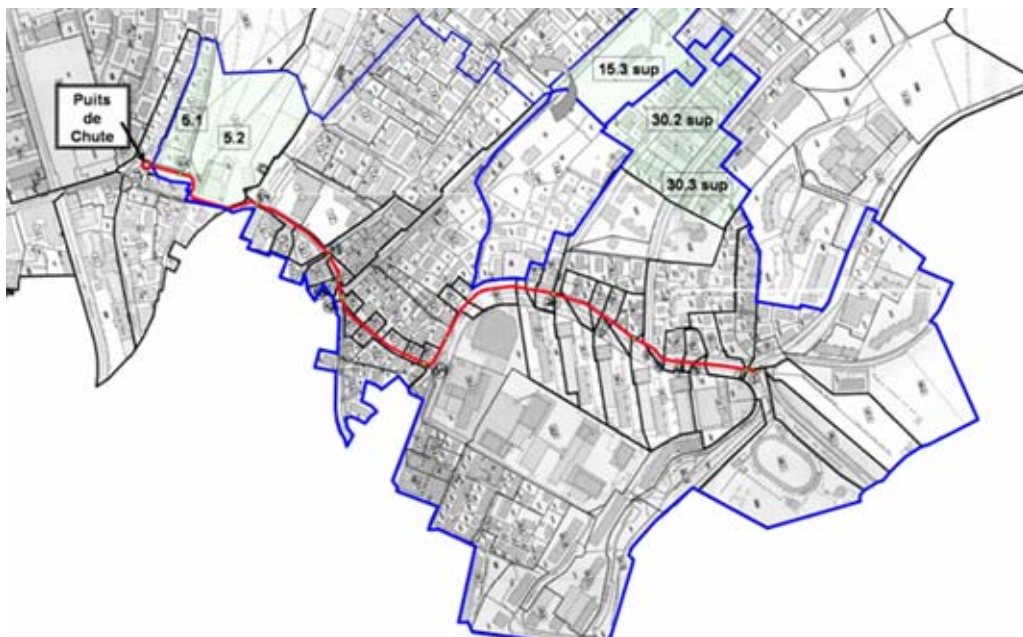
Plan du système de collecte des eaux - modifications de raccordement étudiées / Map of the waste water drainage system - studied connection modifications
